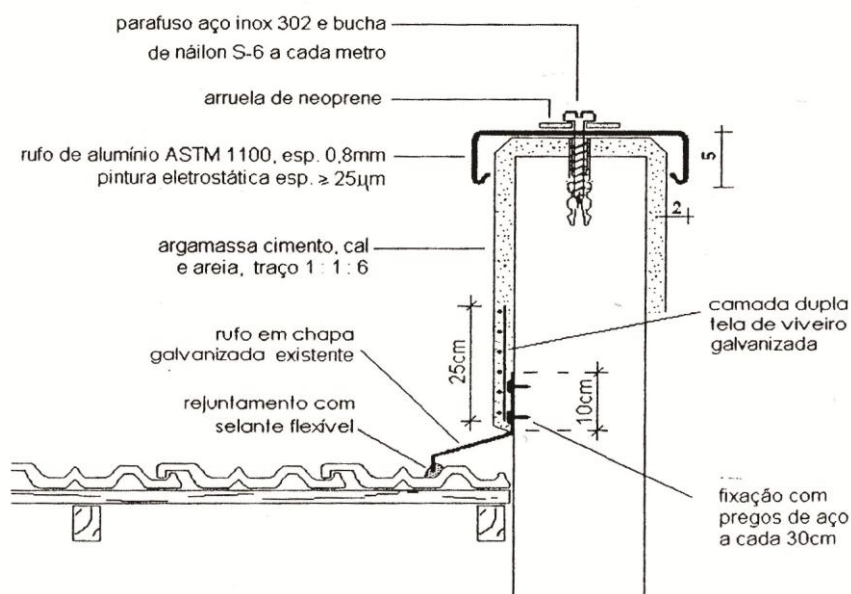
Detalhes de rufo existente em aço galvanizado e rufo em alumínio a ser instalado no topo das platibandas dos telhados e lajes de cobertura das escadarias (IPT, 2007).
